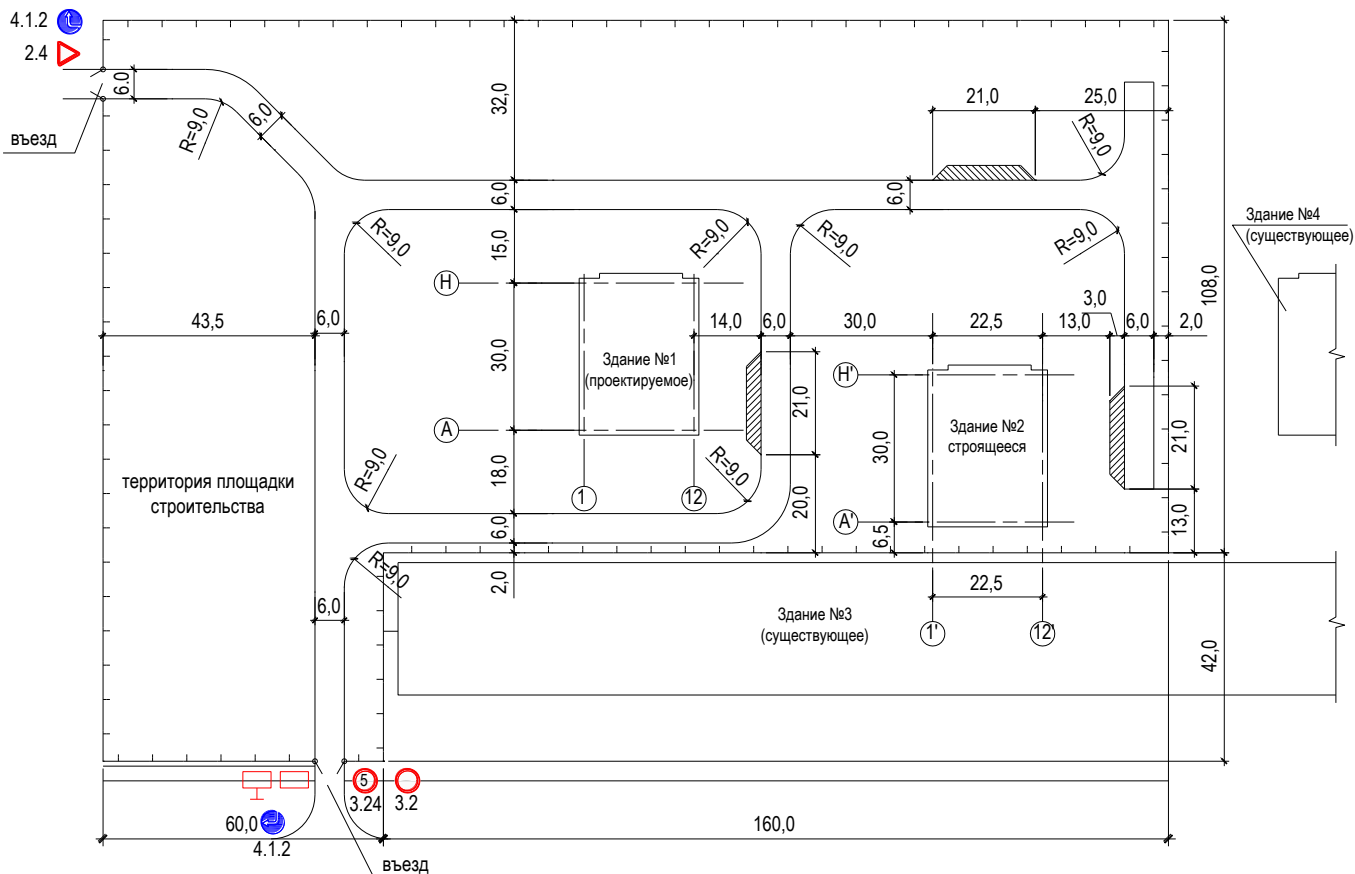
Стройгенплан с нанесёнными стоянками автотранспорта под разгрузку/погрузку.
